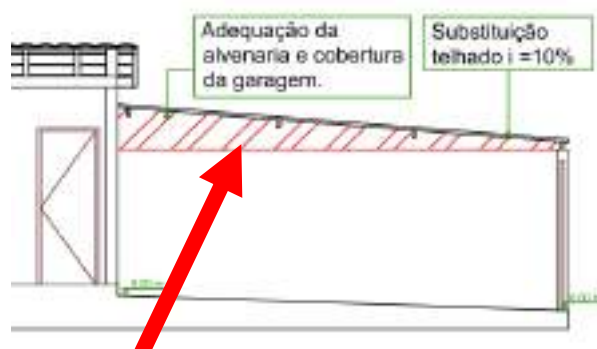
Vista do projeto prevendo a ampliação da parede da Garagem.
